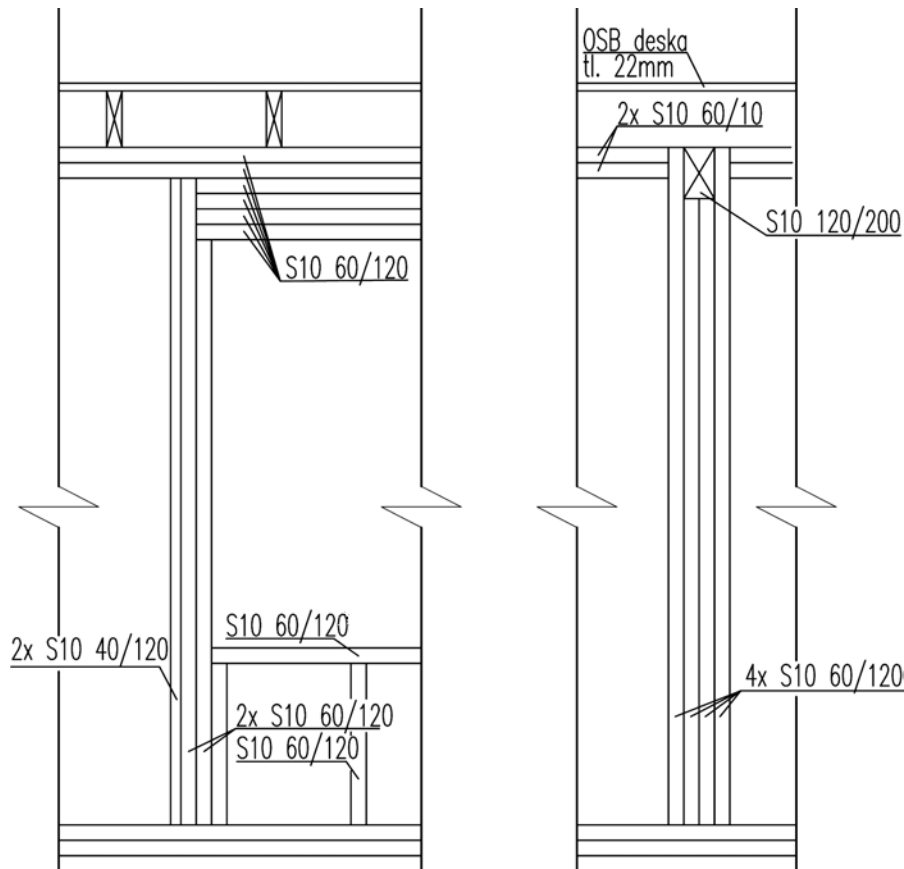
Provedené vnitřní nosné stěny se skrytými sloupy
